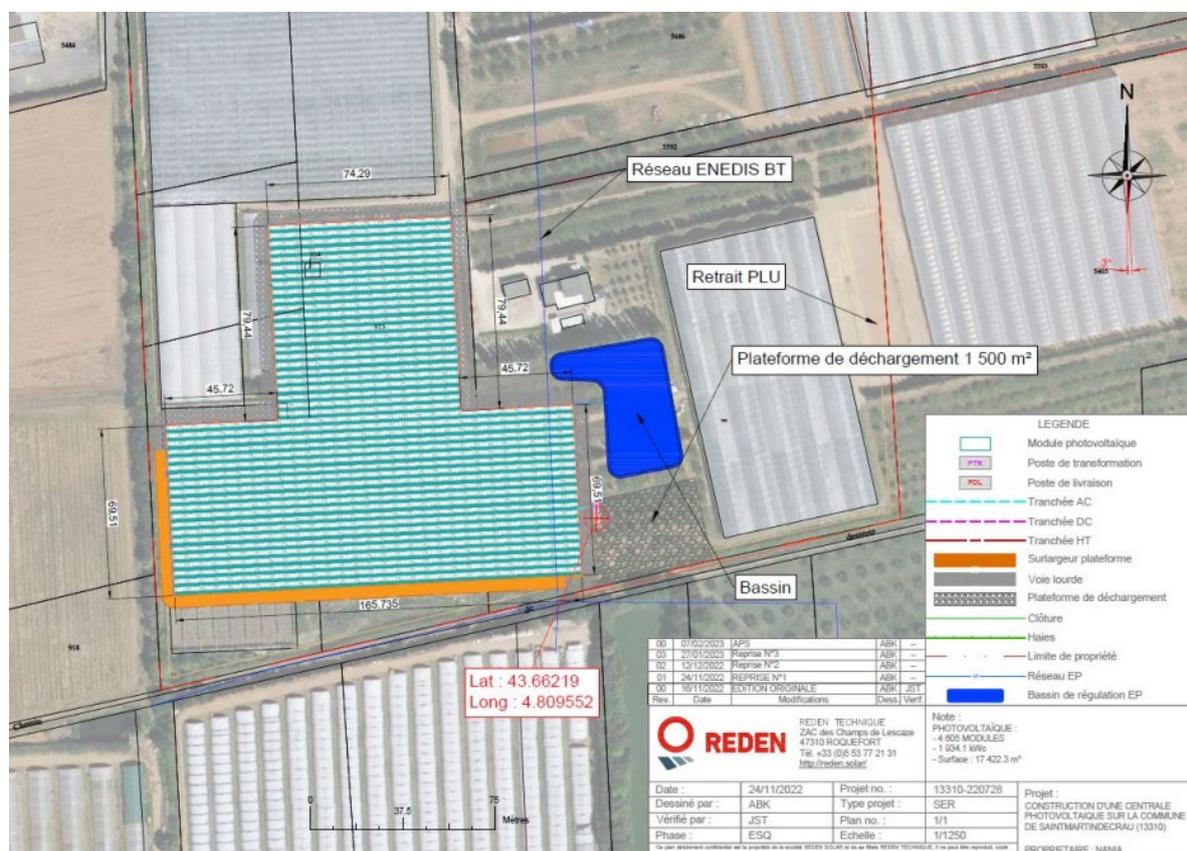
Implantation du projet : plan de la serre. Source : REDEN, 2022.
